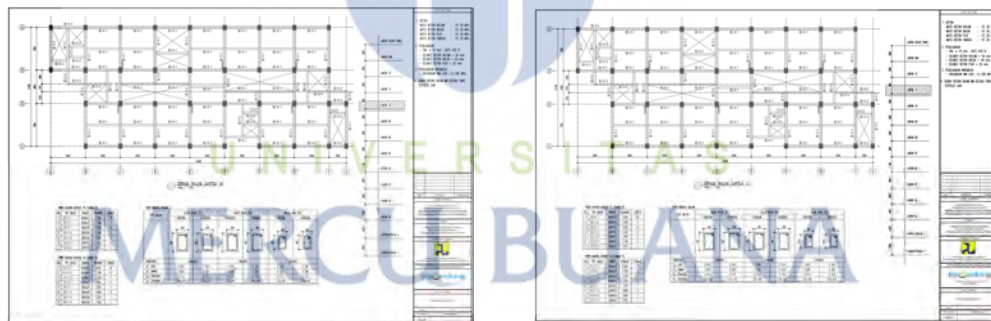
2 Detail struktur balok lantai 4 dan 5
